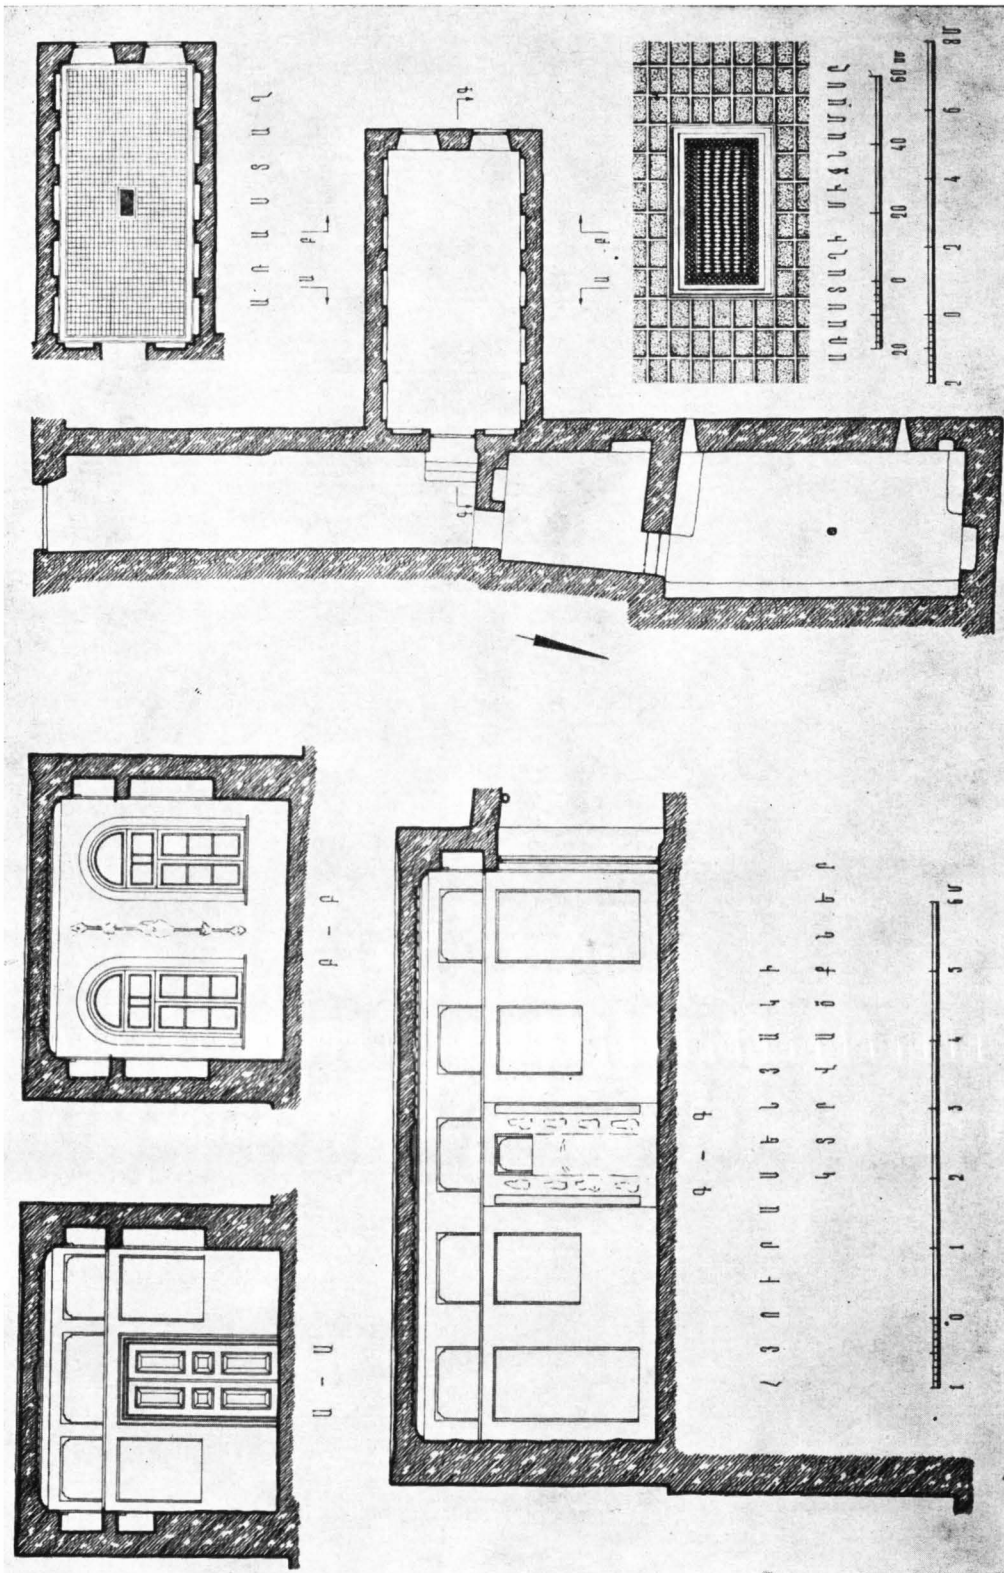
Maison de type ancien avec salon de Meghri (coupes, plan, plafond et fragment du plafond).
